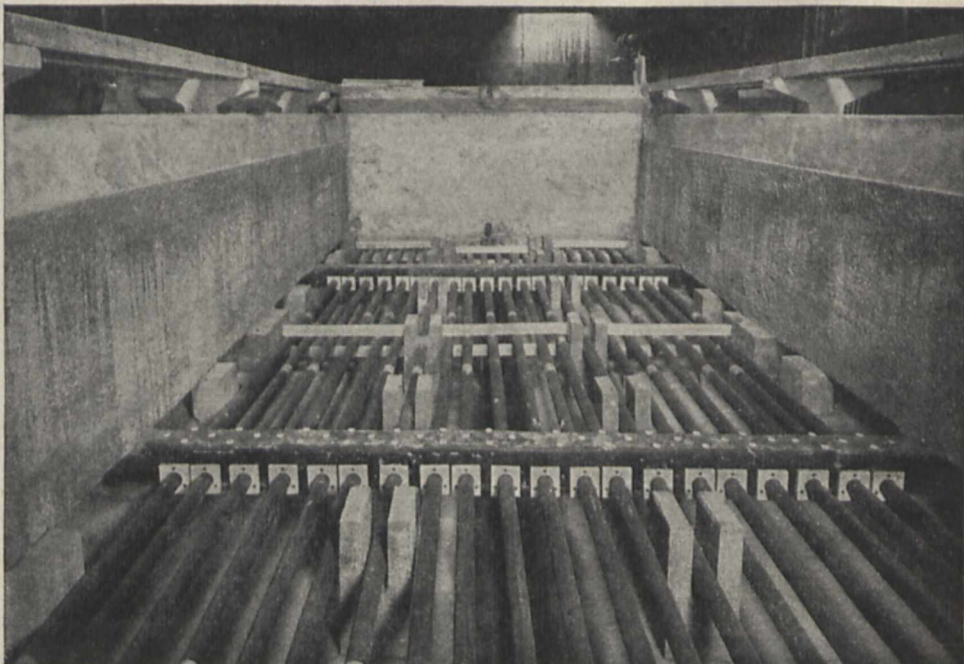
Belüftungsanlage mit Hauptluft- und Blasrohren aus Asbestzement.
